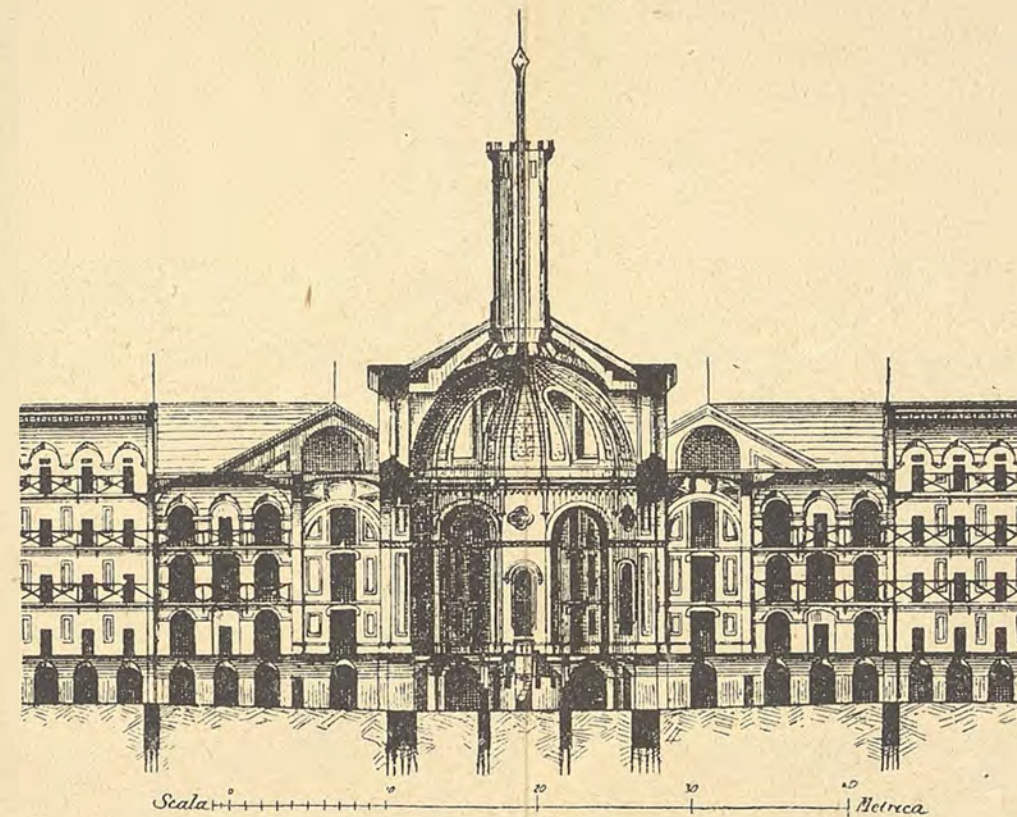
Porzione di sezione longitudinale dell'osservatorio a bracci cellulari.
